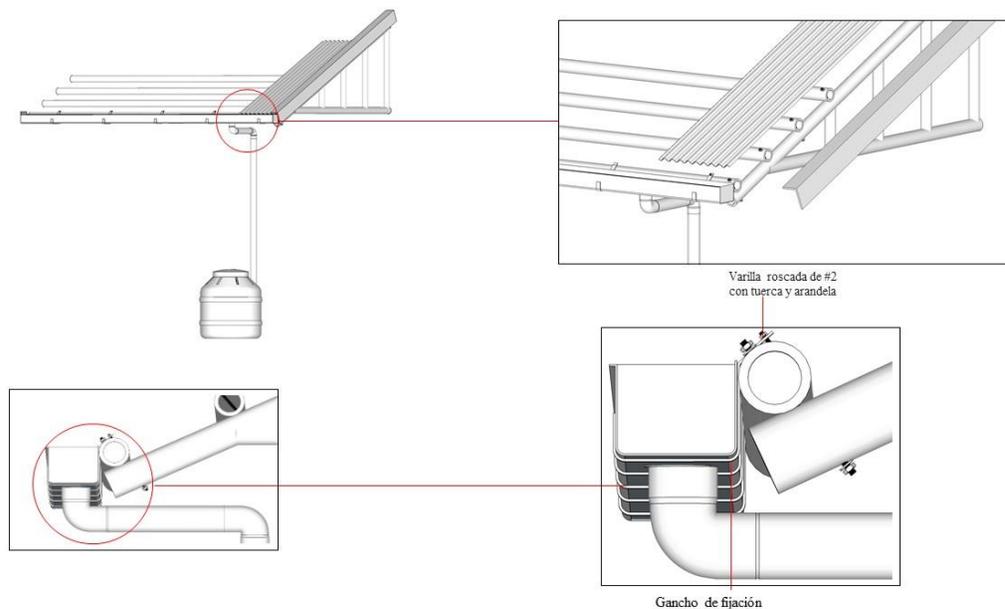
Detalles constructivos del sistema de recolección de aguas lluvia. Fuente: Autor.
